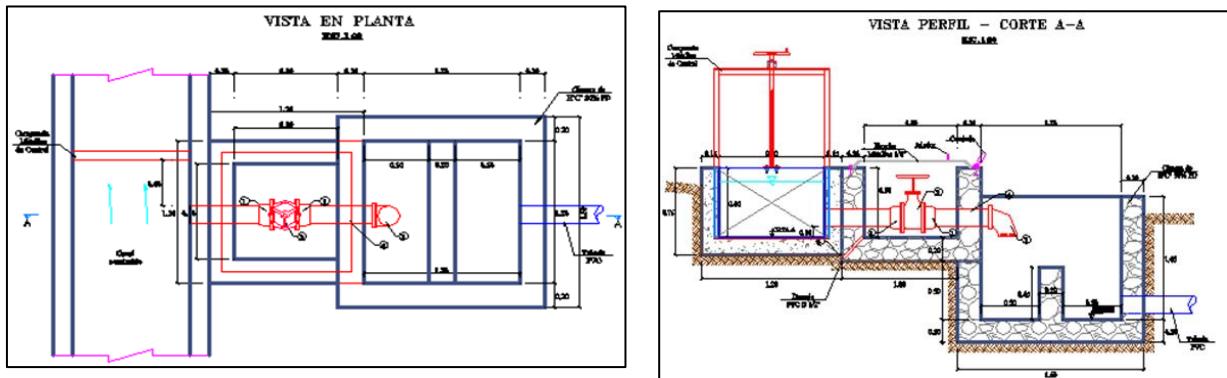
Vista en planta y en corte de la cámara hidrantes fin tubo
